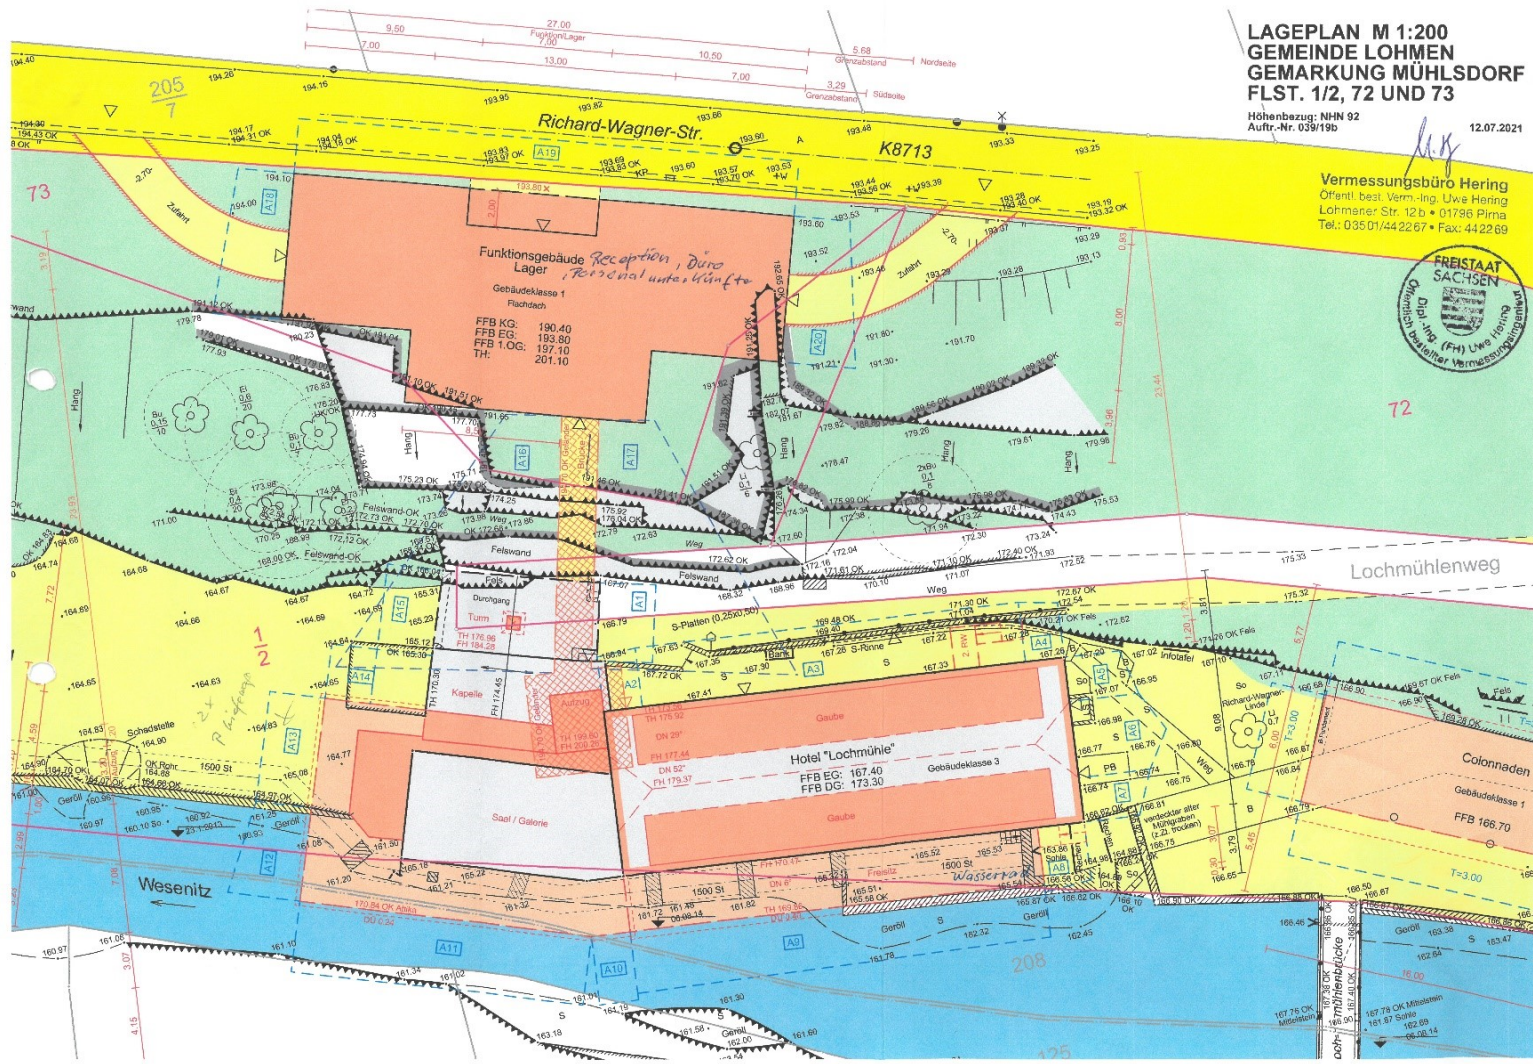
Lageplan / Detail Baufelder 1-3 (Lochmühle, Funktionsgebäude, Colonnade) (Vermessungsbüro Hering, 2021)
